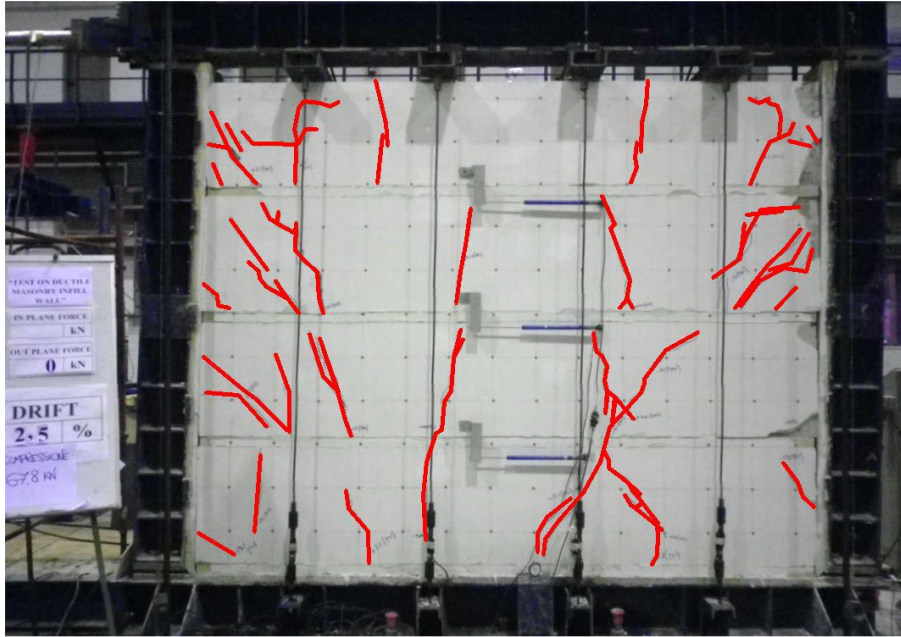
Quadro fessurativo al termine della prova sulla parete in laterizio con giunti orizzontali e precompressione oggetto della tesi precedente (Vecchi, 2014)
